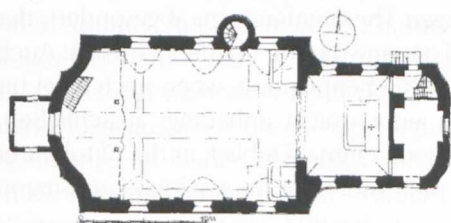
Ingenried (Lkr. Weilheim-Schongau), Pfarrkirche St. Georg, Grundriß (Bayerische Kunstdenkmale, Bd. XXIII, München 1966, S. 108)
